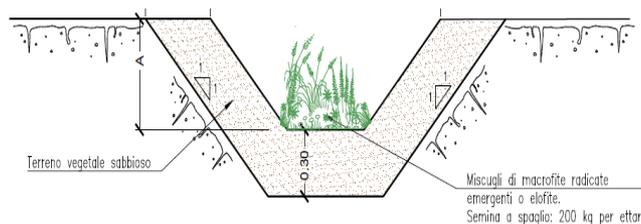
Fossi di Guardia – Sezione Tipo in Terra con Biofiltro
